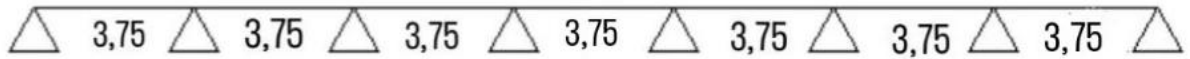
Schéma statique de la poutrelle a 7 travées.
